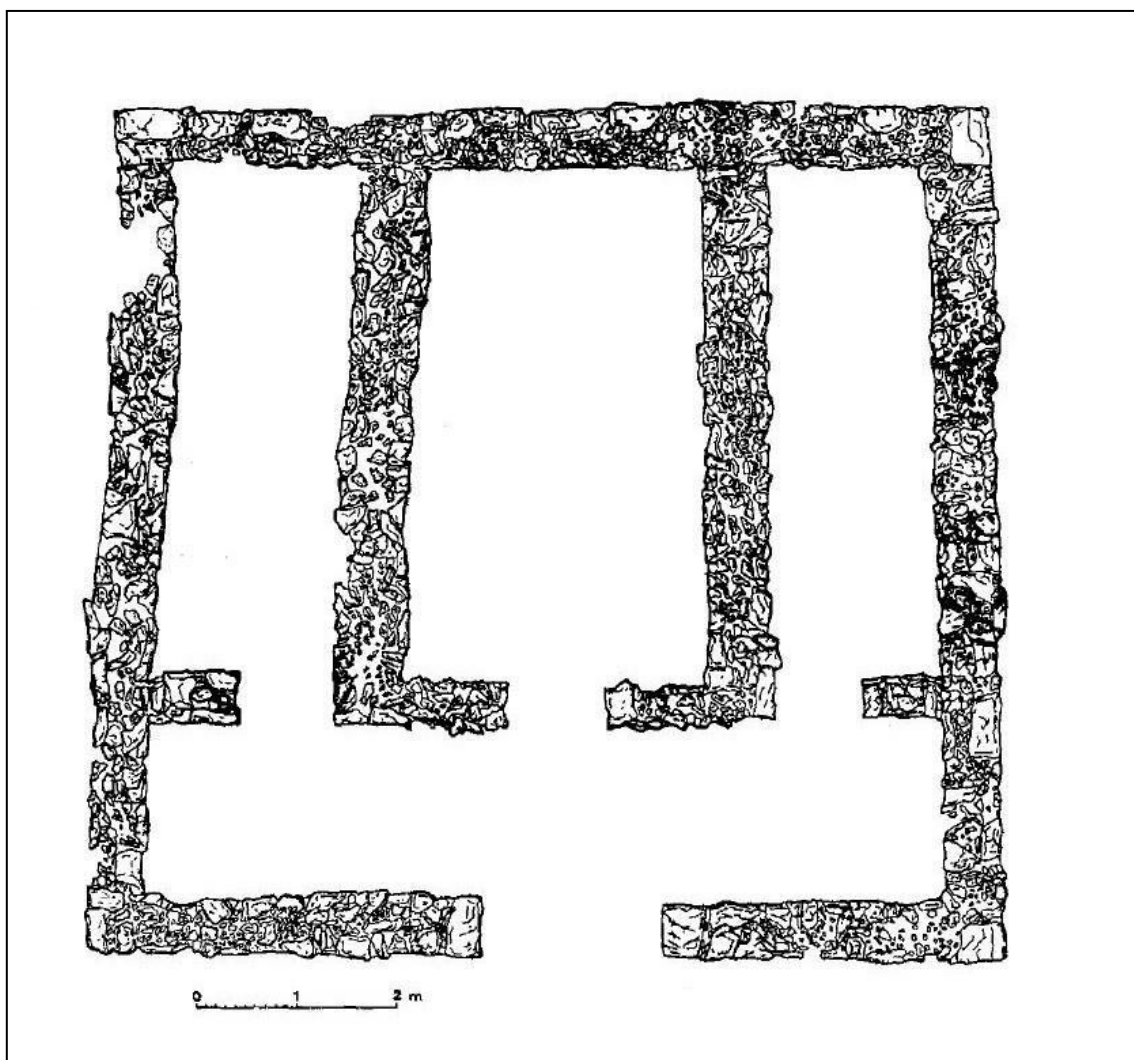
Planimetría del Edificio 1 de Tres Hermanas.
